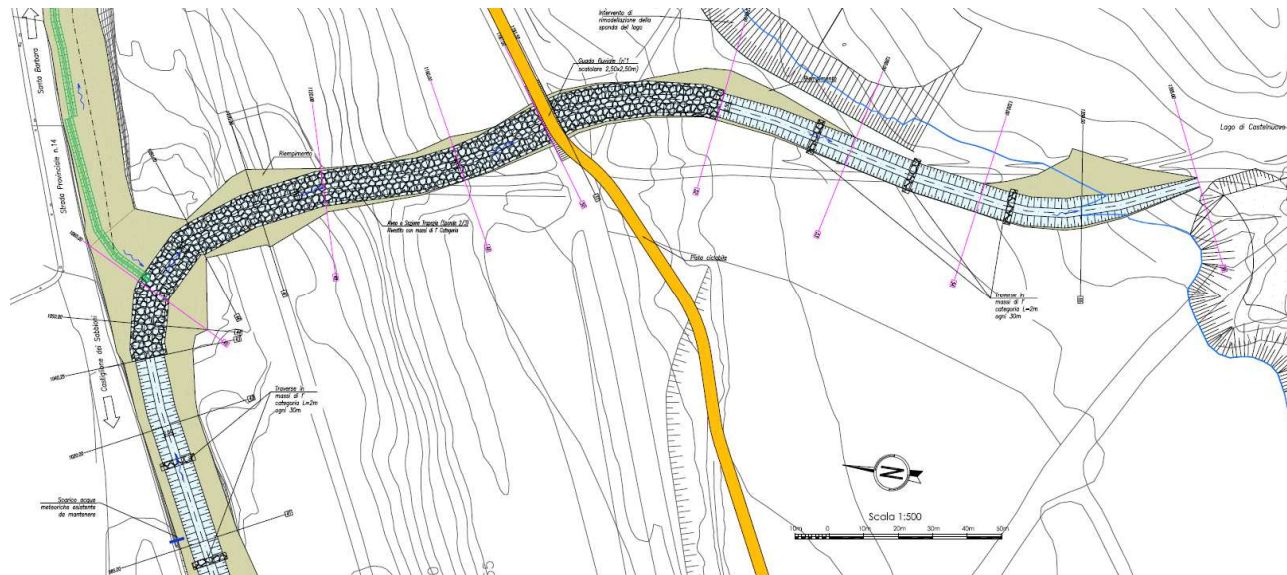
Planimetria tratto 3 di 3 di risagomatura del borro Lanzi
